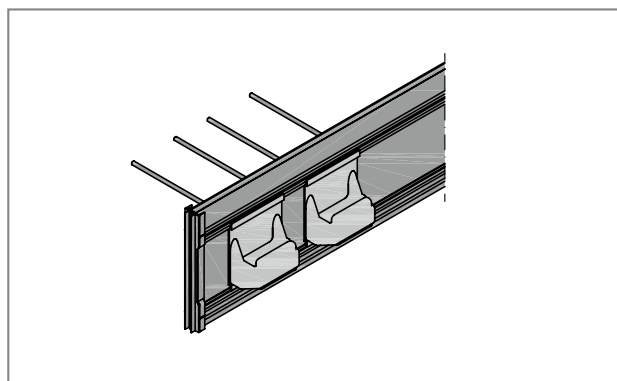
Schöck Tronsole® type T : Detail support bracket positive fabrication
